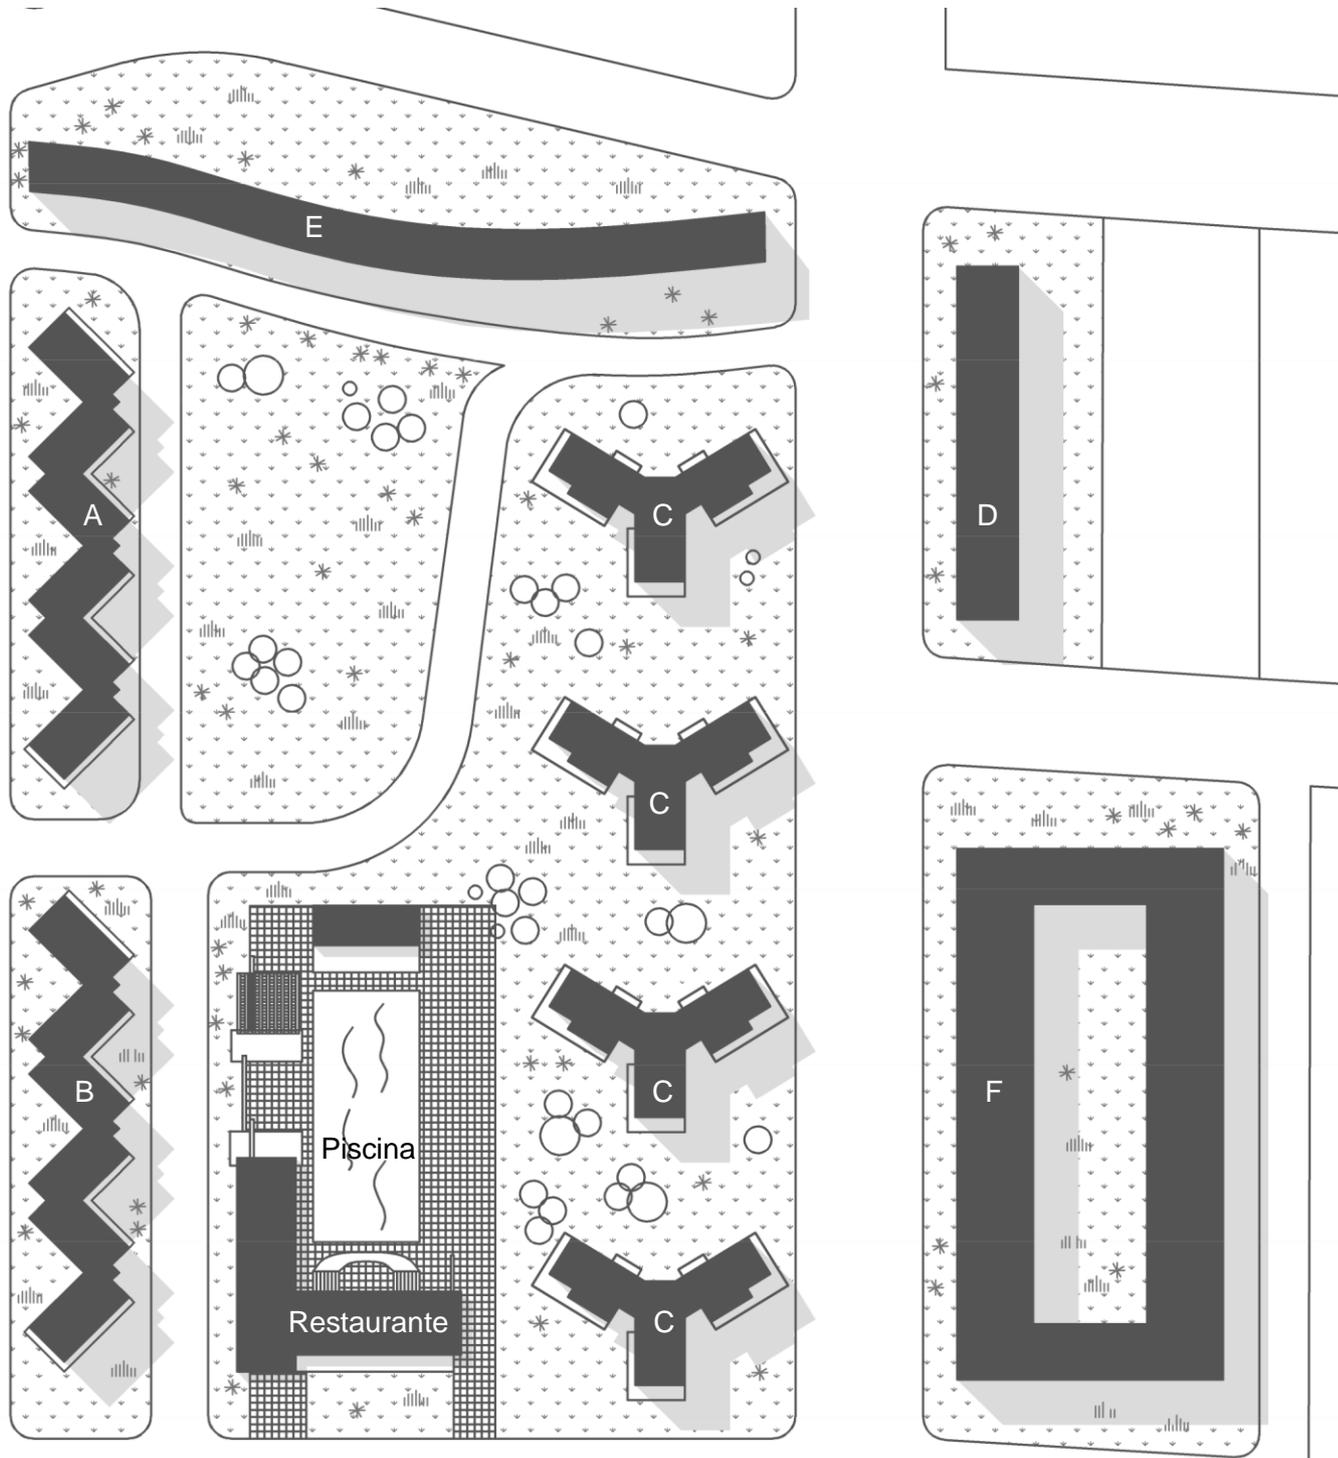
Planta del conjunto 1/1000, Proyecto redactado diciembre 1961. Elaboración propia.
